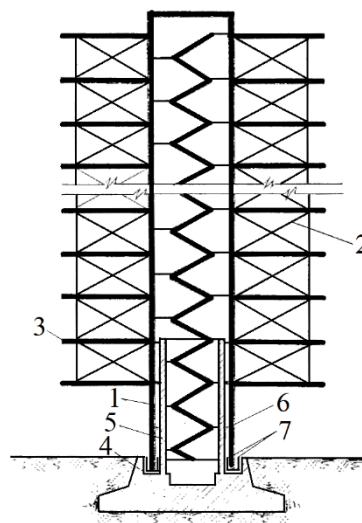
Сейсмостойкое здание Г.Г. Семенца: 1 – опорная башня; 2 – диафрагмы жёсткости; 3 – плиты перекрытия; 4 – фундамент; 5 – ядро жёсткости; 6 – упругие прокладки; 7 – амортизирующие устройства
